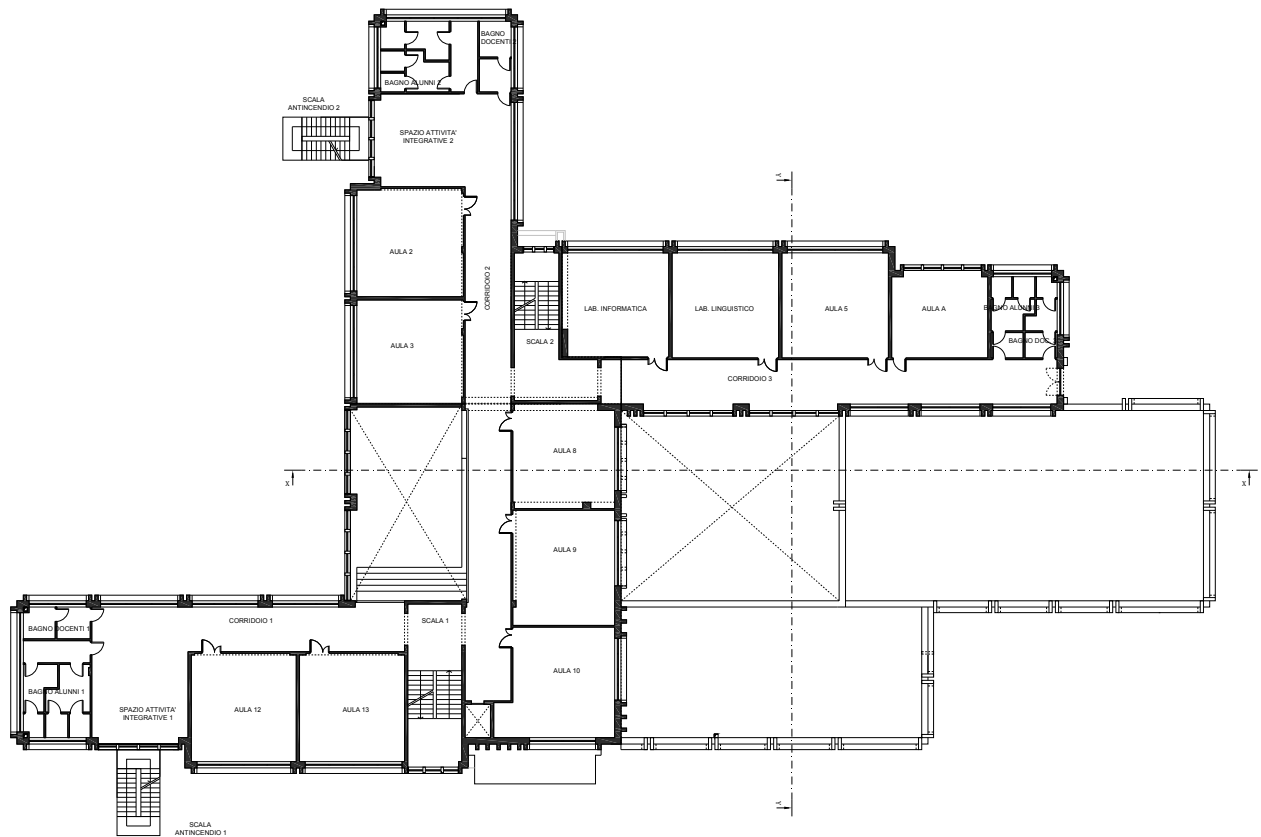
Pianta Piano Primo dell'Edificio
